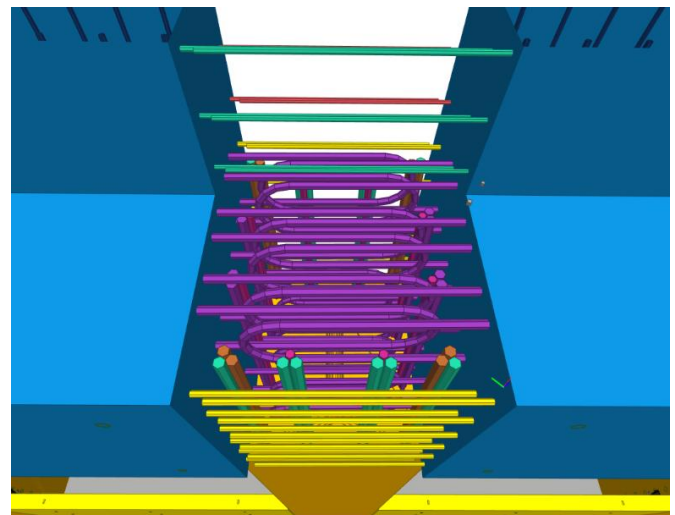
Vista del modelo en el encuentro de los pilares prefabricados con los dinteles prefabricados, nudo húmedo, previo al hormigonado in situ del mismo.
